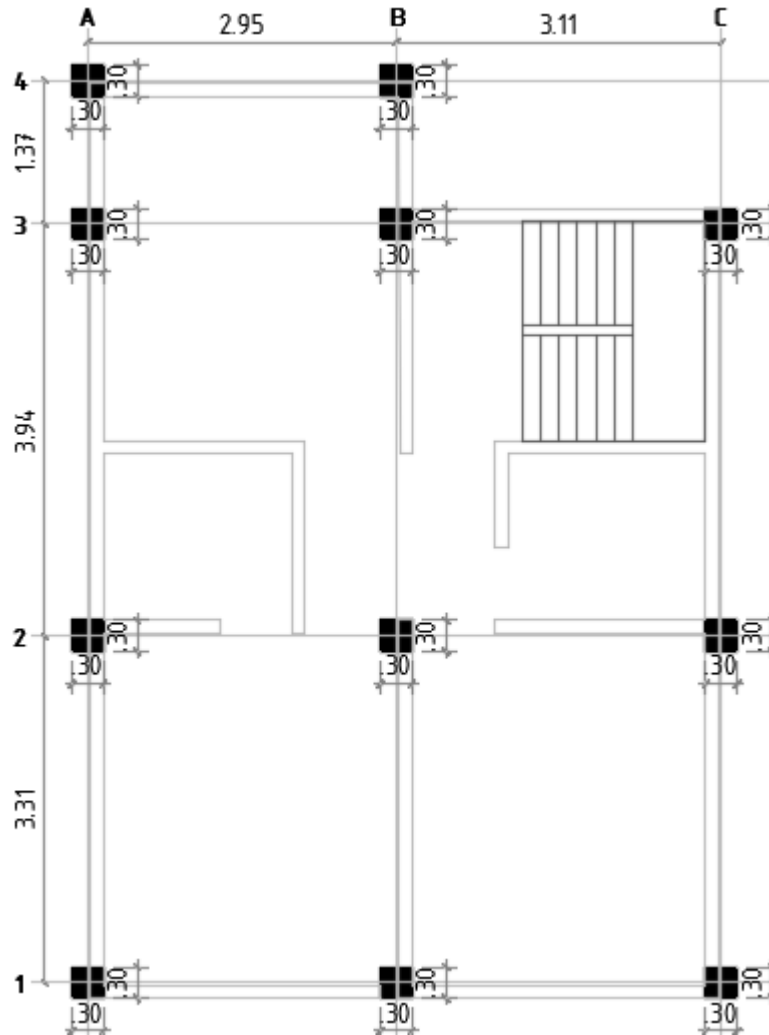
Configuración en planta con la ubicación de las zapatas aisladas
